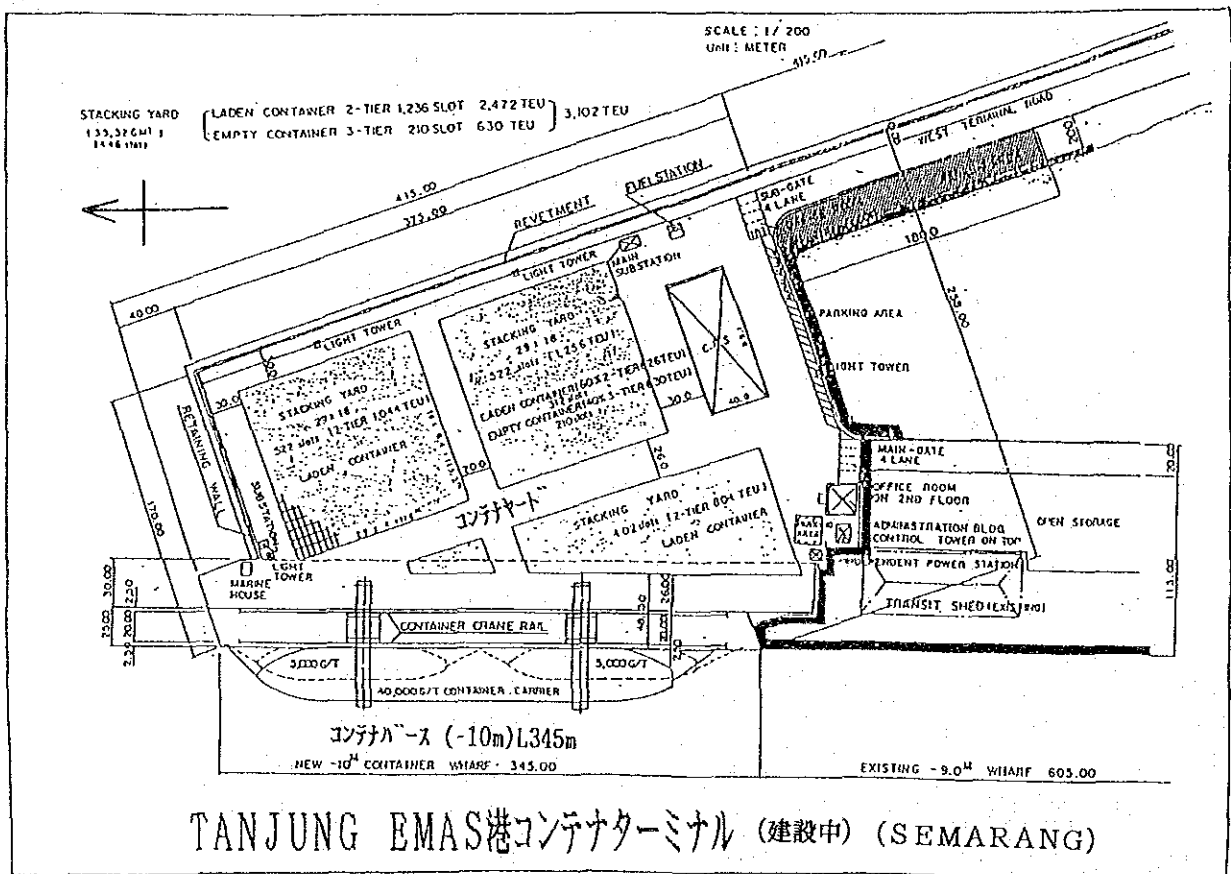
コンテナターミナル平面図 (タンジュンエマス港)
